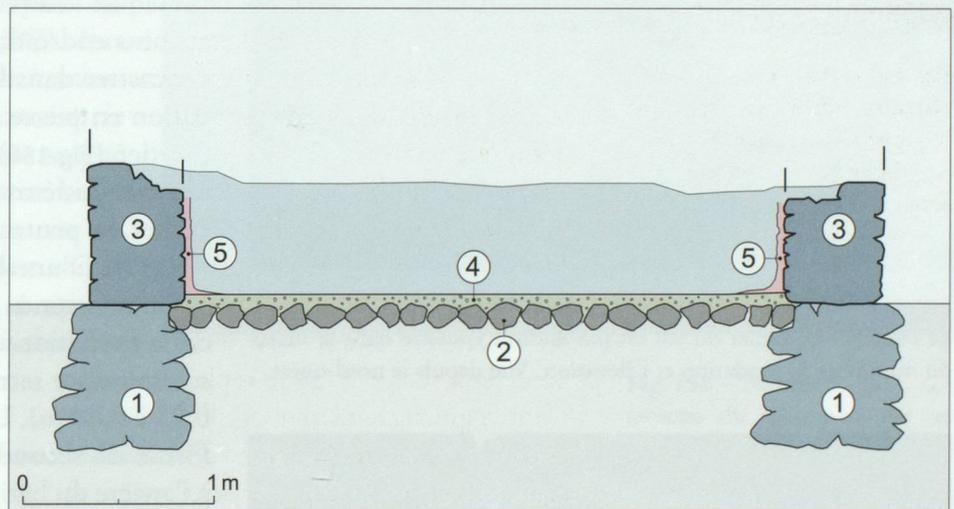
Bâtiment Bat1. Coupe schématique est-ouest illustrant les étapes de construction de l'édifice. 1. fondations, 2. radier du sol, 3. élévation, 4. *terrazzo*, 5. enduit mural.
